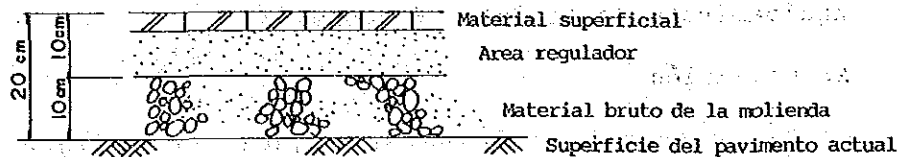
CORTE TRANSVERSAL DEL PAVIMENTO
